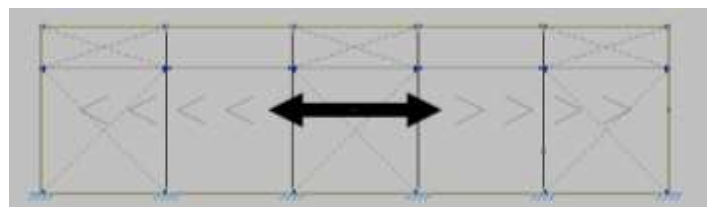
Distribucion cargas laterales. Fuente-CYPE
